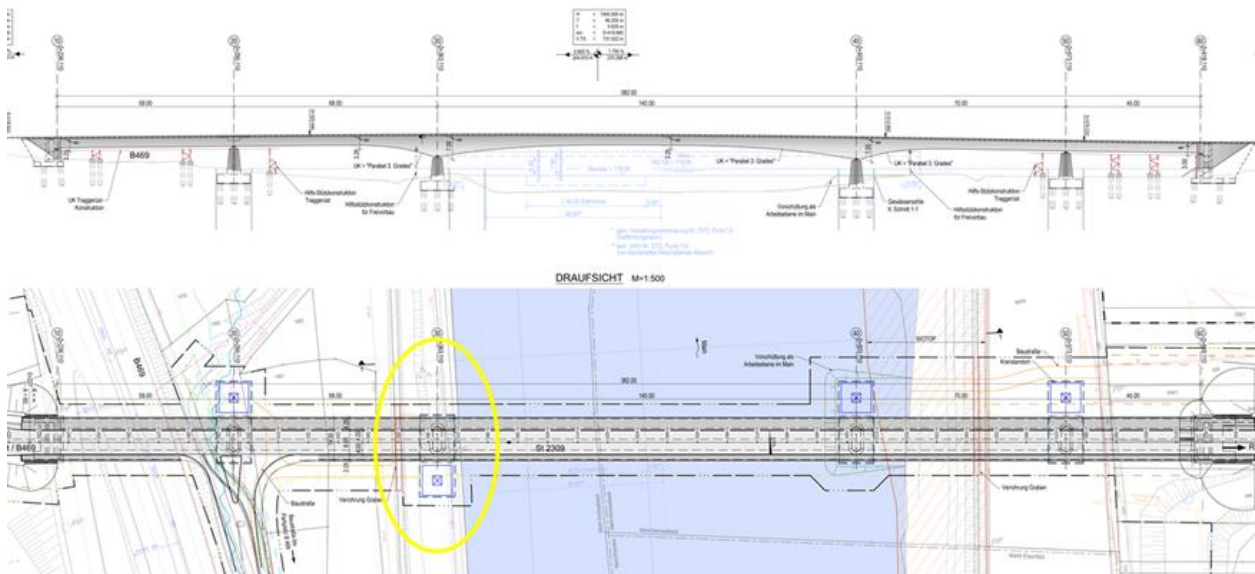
Lageplan und Querschnitt Planung Stand März 2025 (SRP)
